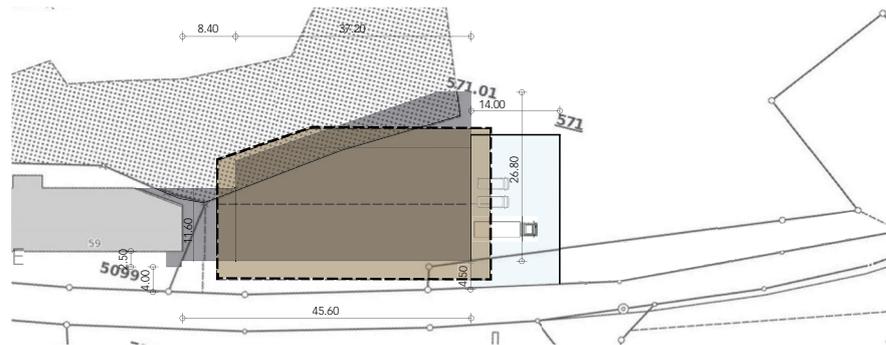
Schematische Ausdehnung der künftigen Bauten und Anlagen. Braun: Dachfläche des neuen Schlachthauses, dunkelgrau: Ausdehnung des Erd- und 1. Obergeschosses, hellgrau: bestehendes Gebäude der Schlachthaus Bödemli AG.
